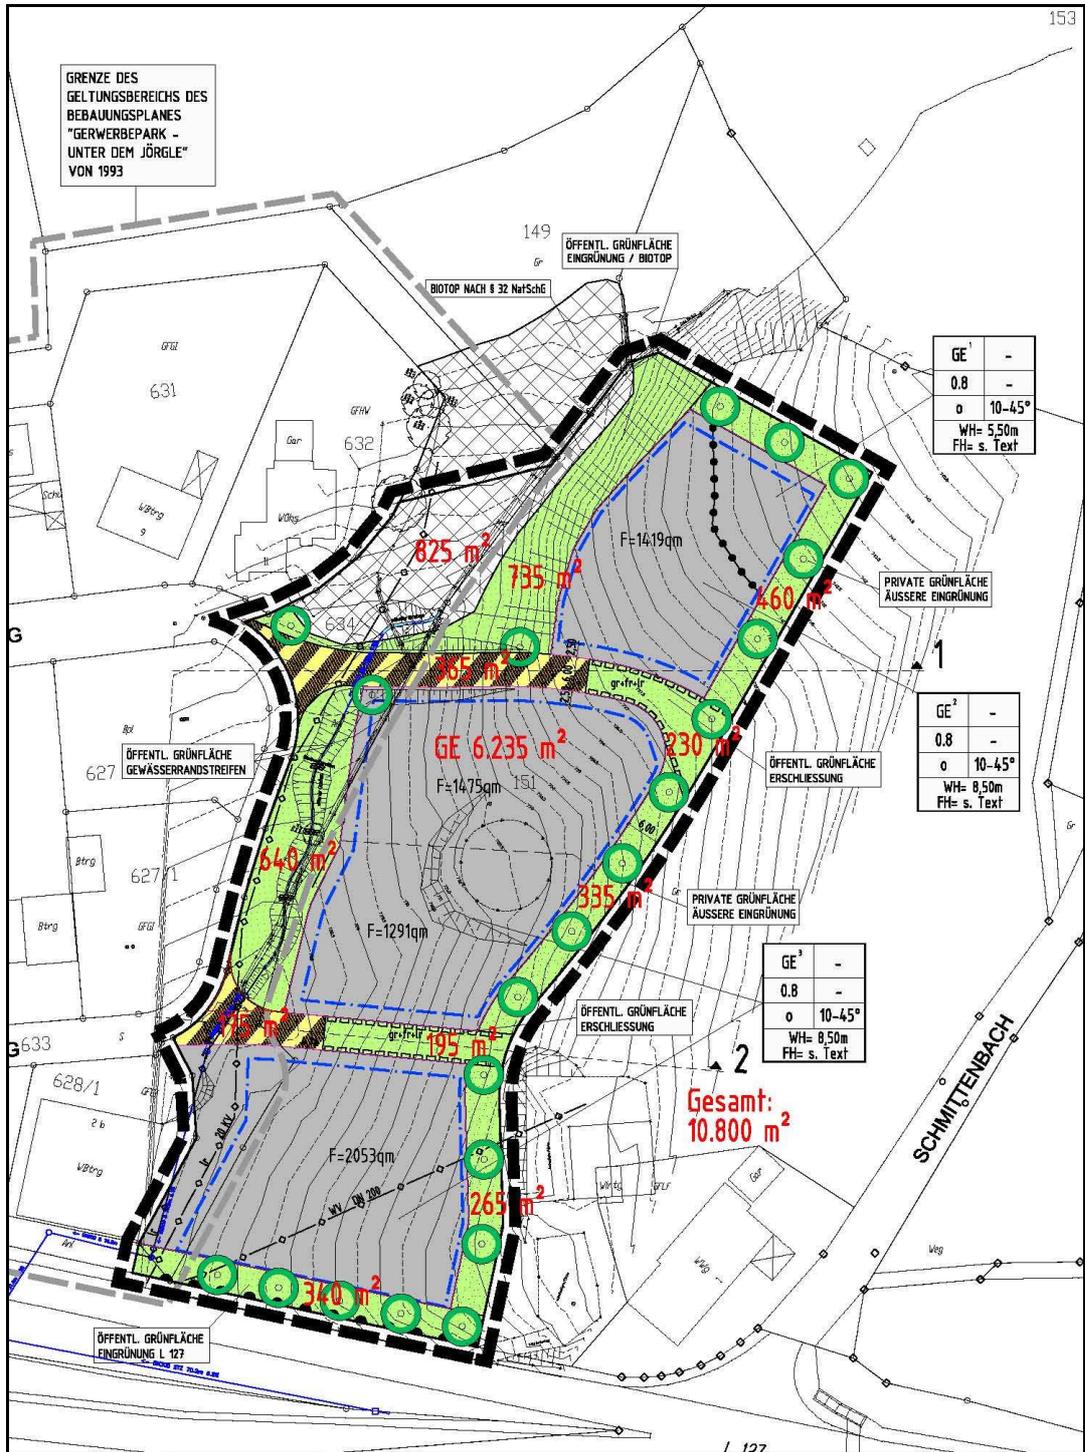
"Flächen Planung"- BP „Erweiterung Gewerbepark Unter dem Jörgle“
